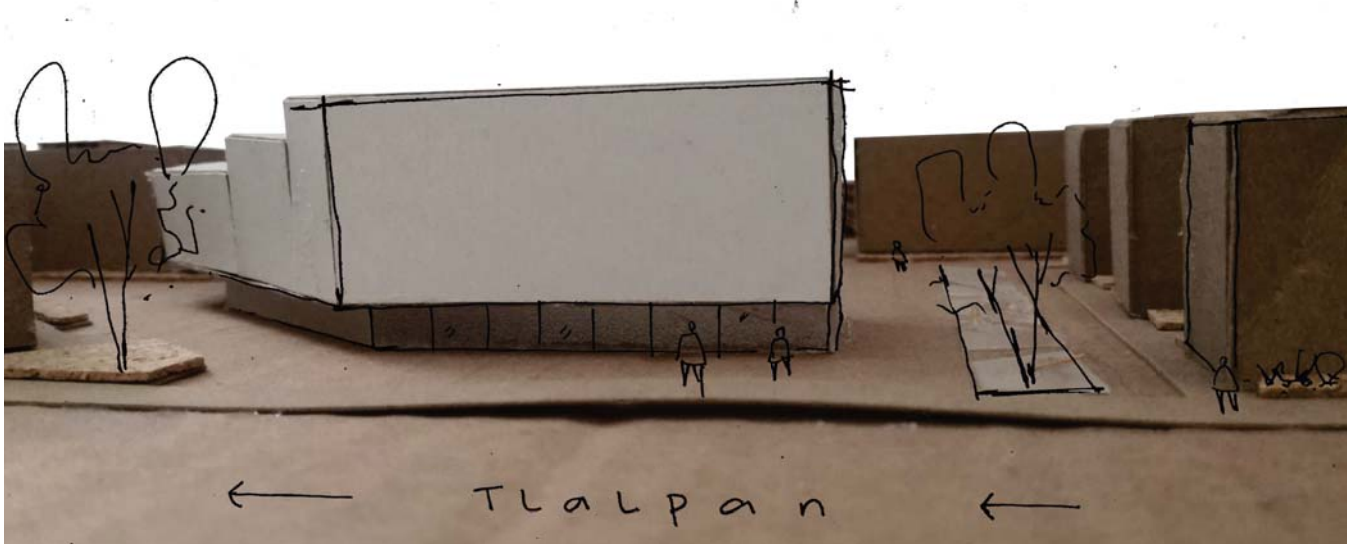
Croquis de fachada sobre fotografía de maqueta.
